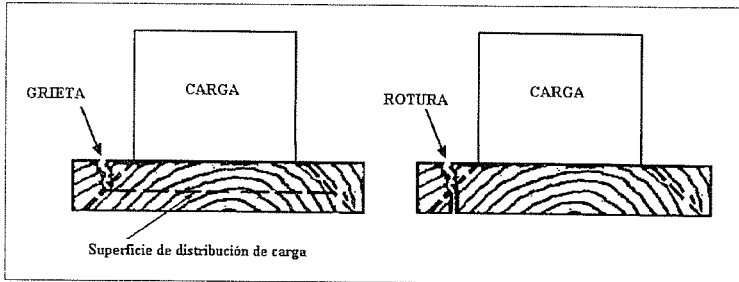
Existencia de grietas en las plataformas
